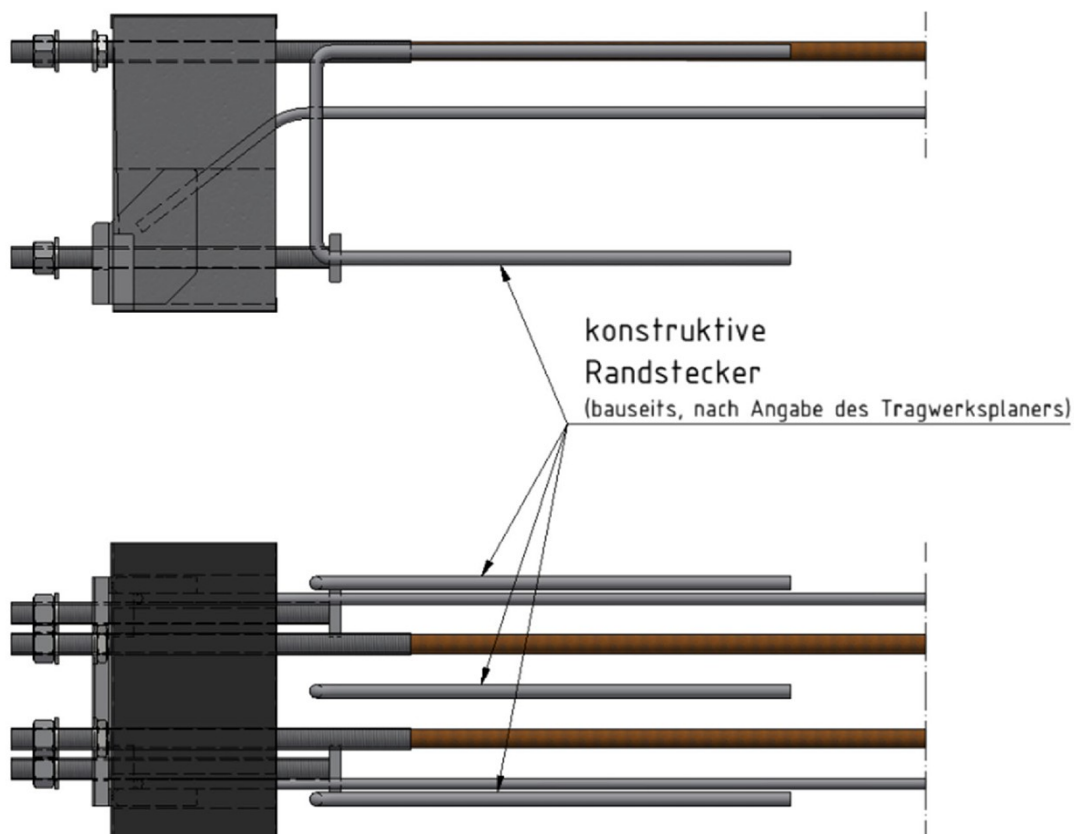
exemplarische Darstellung konstruktive Randsteckbügel im Lasteinleitungsbereich
